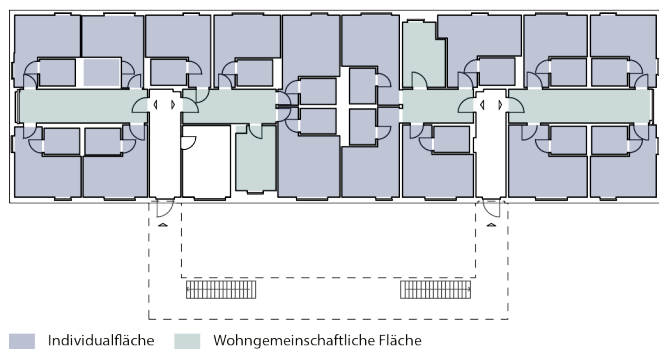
Grundriss Erfurt BSZ, Regelgeschoss, M
